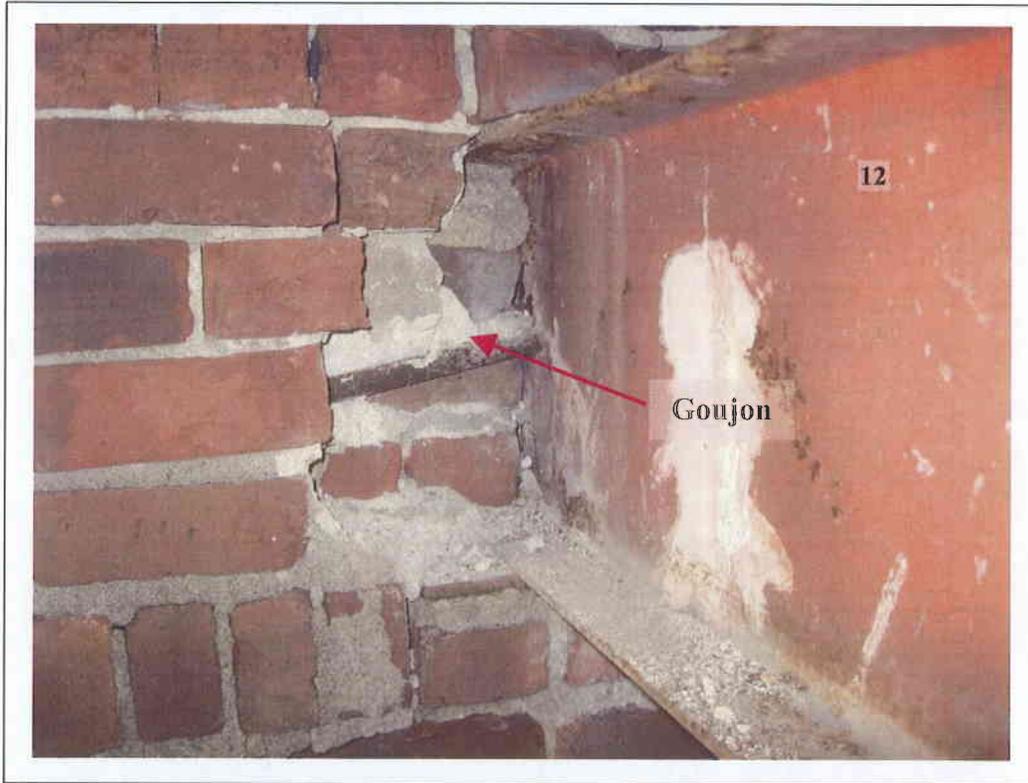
Jonction de la poutre No. 12 avec le mur porteur.
